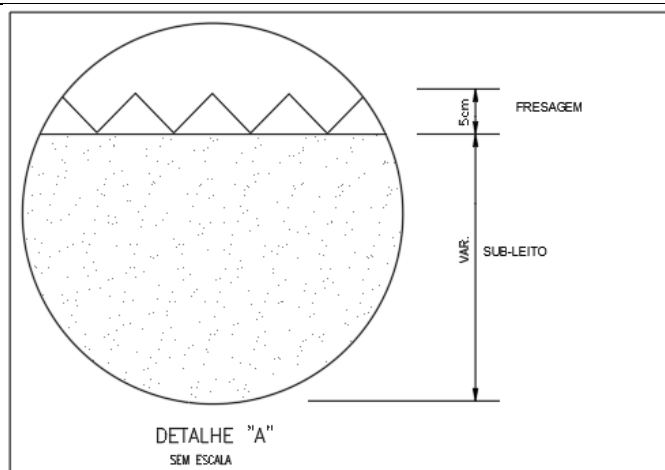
Detalhamento da Seção Tipo Pavimentação
